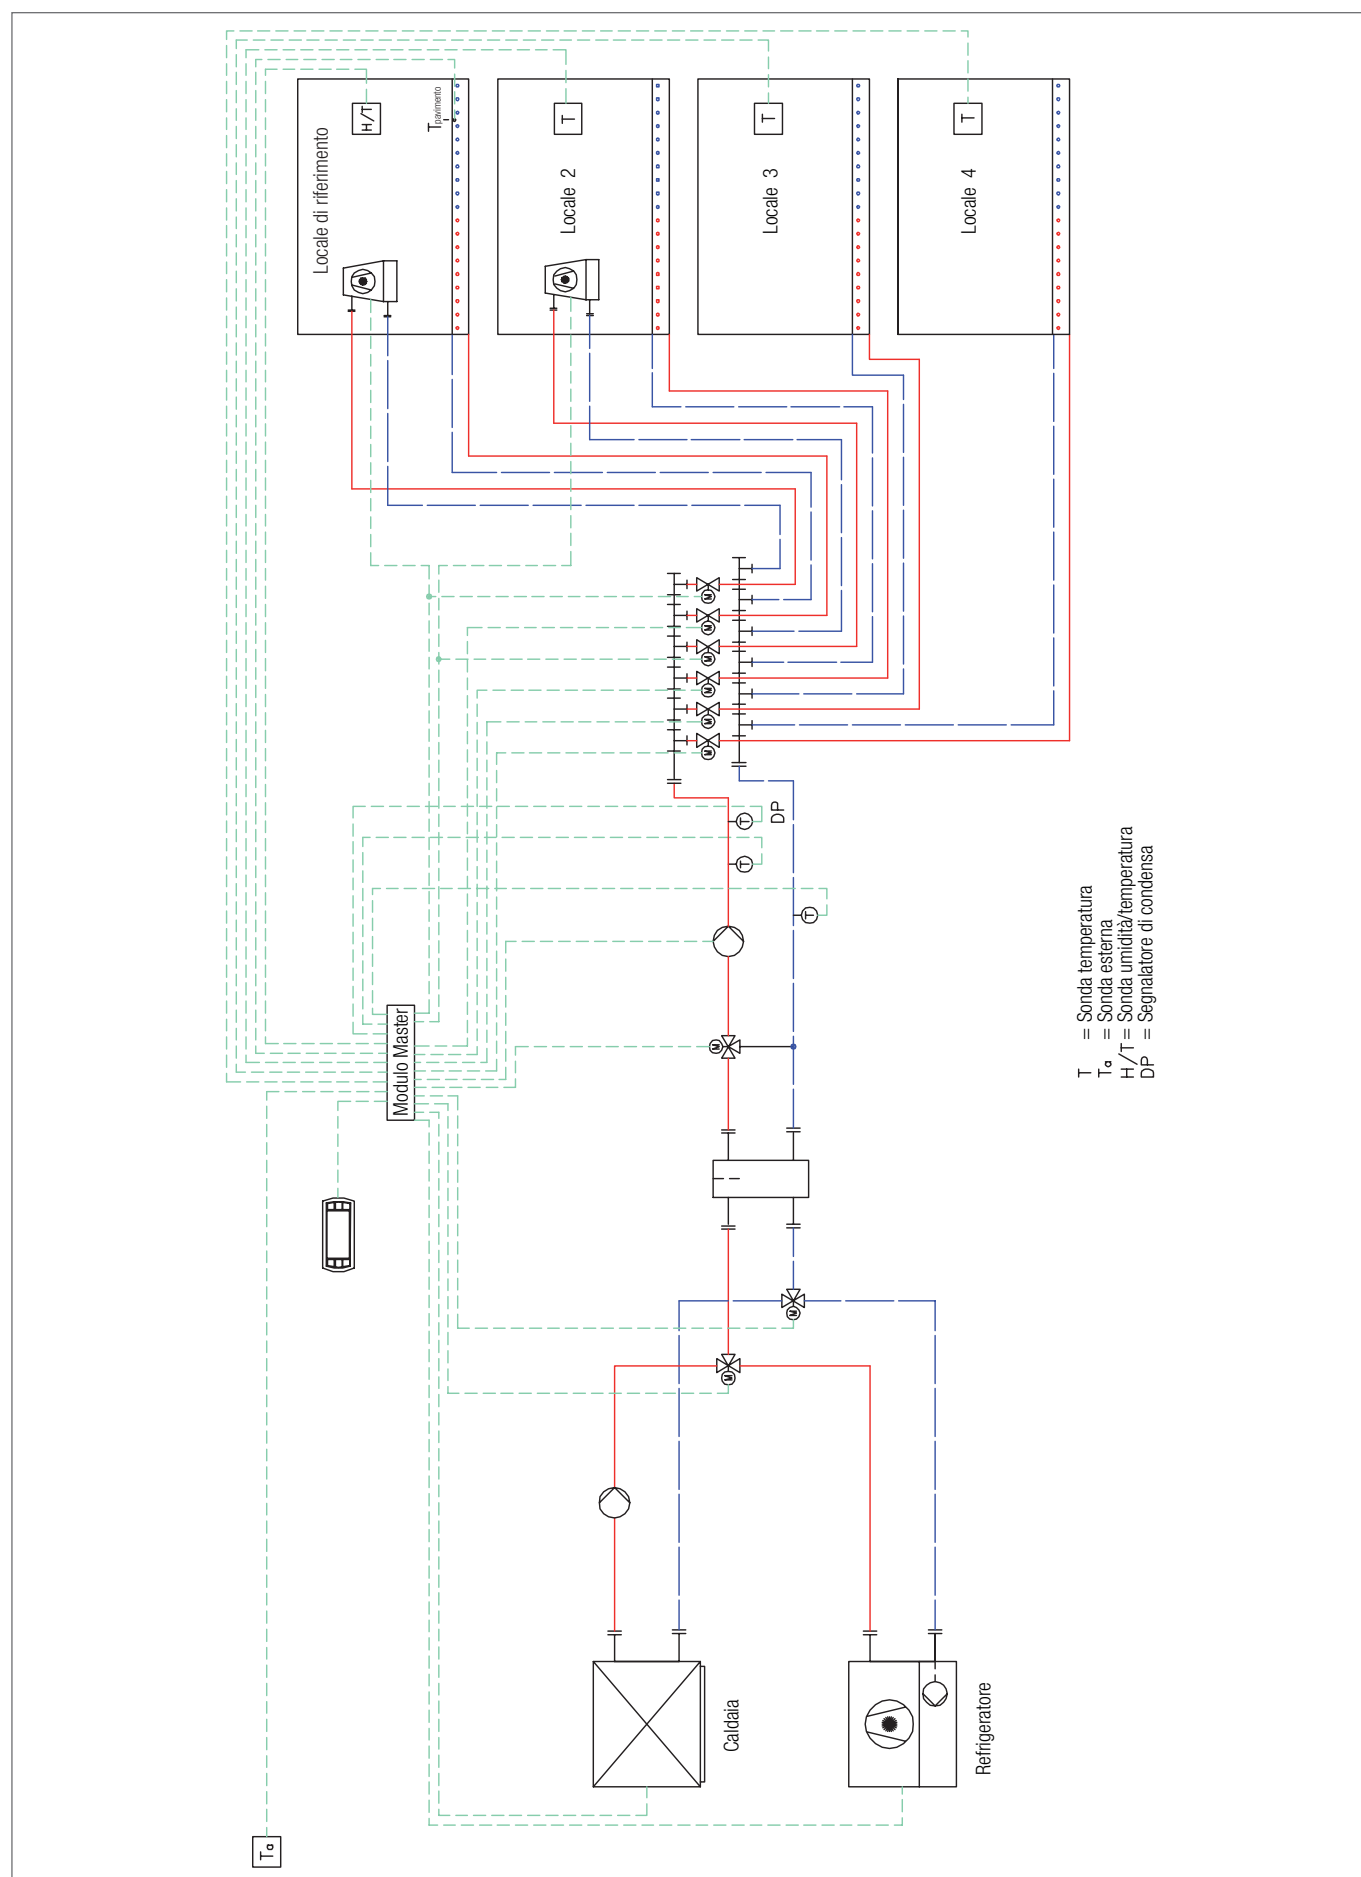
Sistema di riscaldamento/raffrescamento a pavimento, 1 zona
